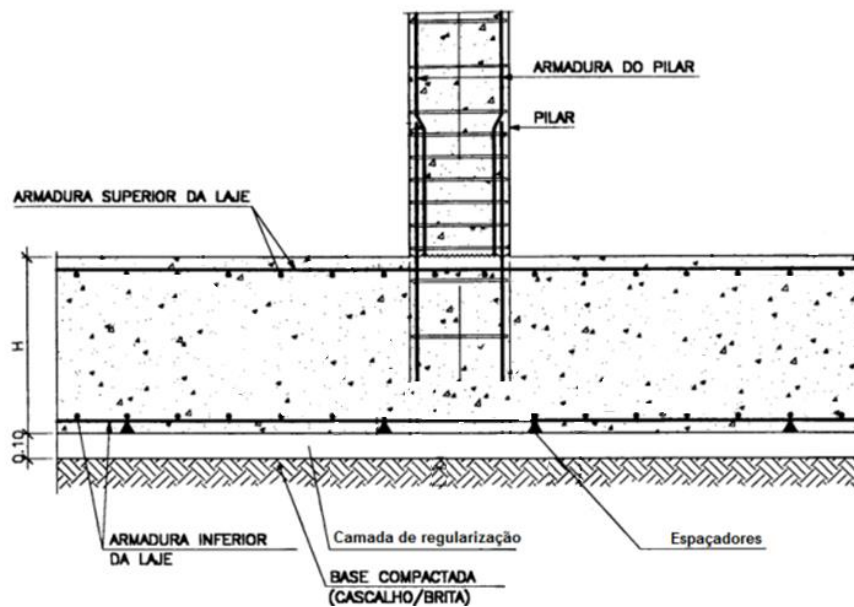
Esquema das armaduras da laje e de arranque dos pilares para um pilar interior (Santos et al., 2000).
